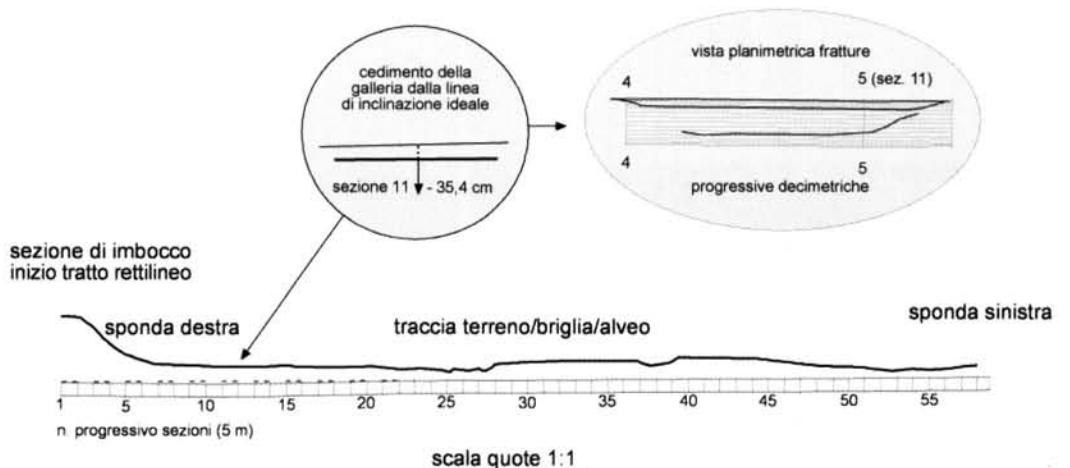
Pianta e sezione del Traversante di Trebbia (grafica M. Chiesi).
